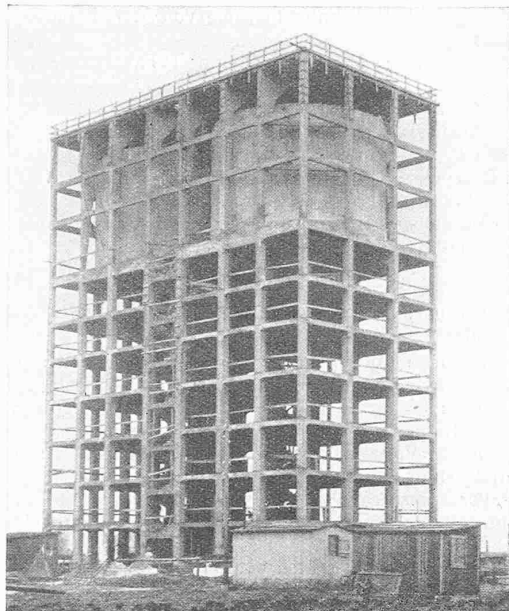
Eisenbeton-Gerippe des Wohn-Wasserturmes.
